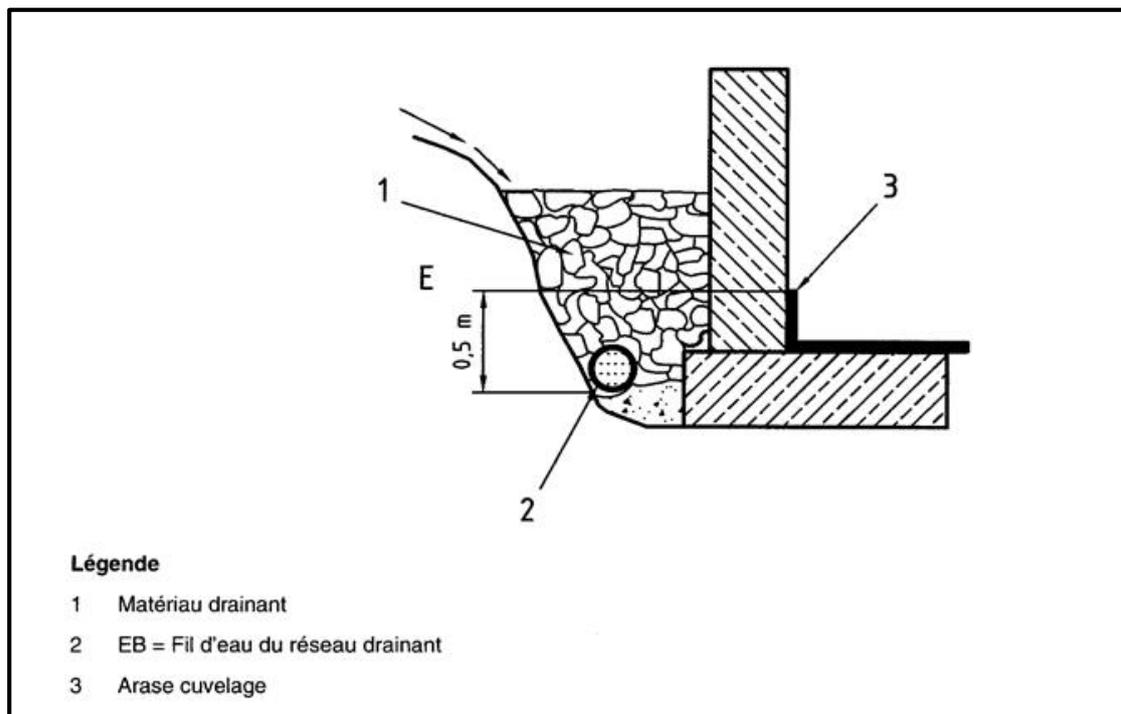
Exemple de cas d'eaux de ruissellement ou d'infiltration avec drainage avec revêtement
